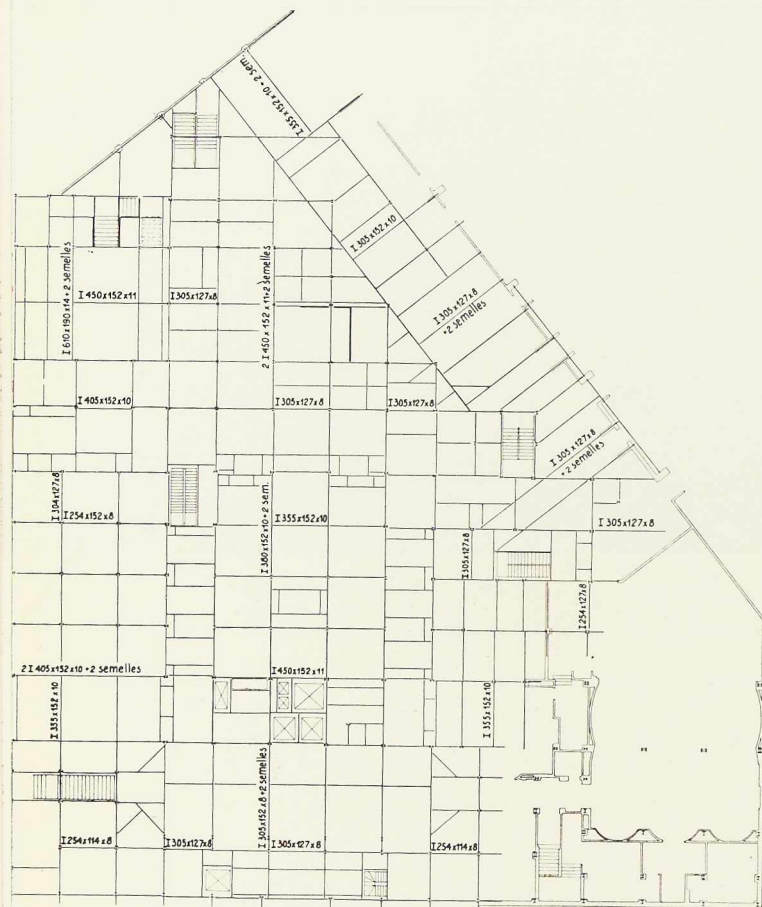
Plan du poutrellage en acier au niveau du premier étage.
